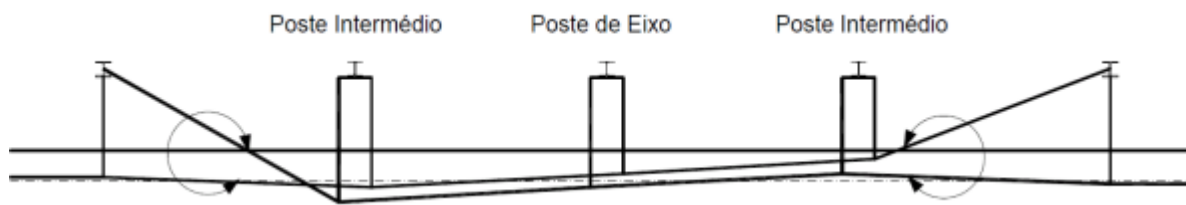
Zona comum e seccionamento de lâmina de ar – representação em planta
